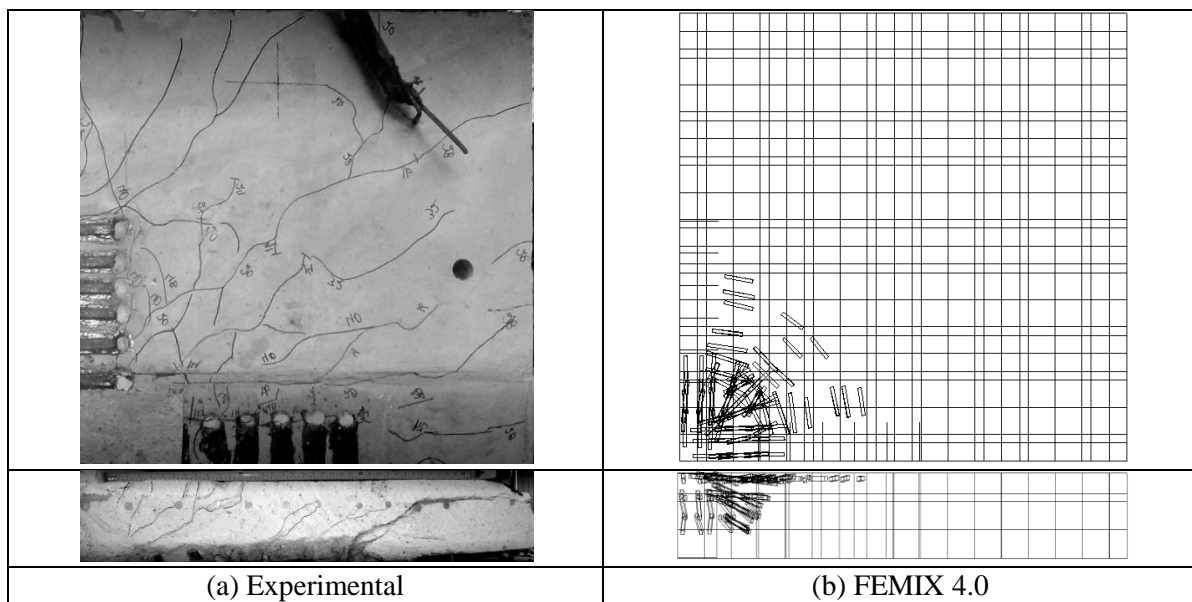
Padrão de fissuração - LC-S1-F1 (FEMIX 4.0)
